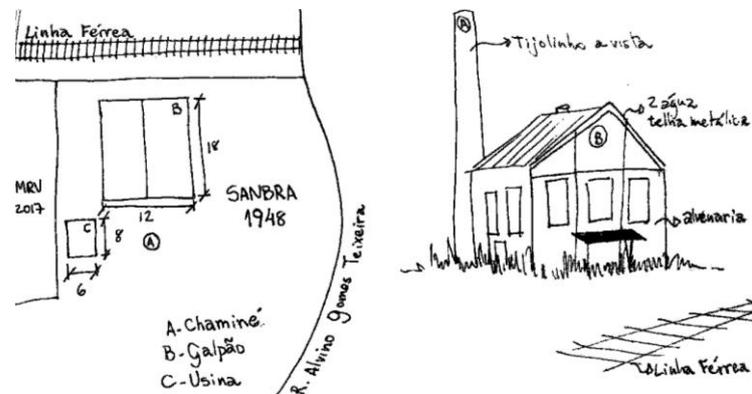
Croquis de planta e testada esquemática dos edifícios, para a rua José Claro.
